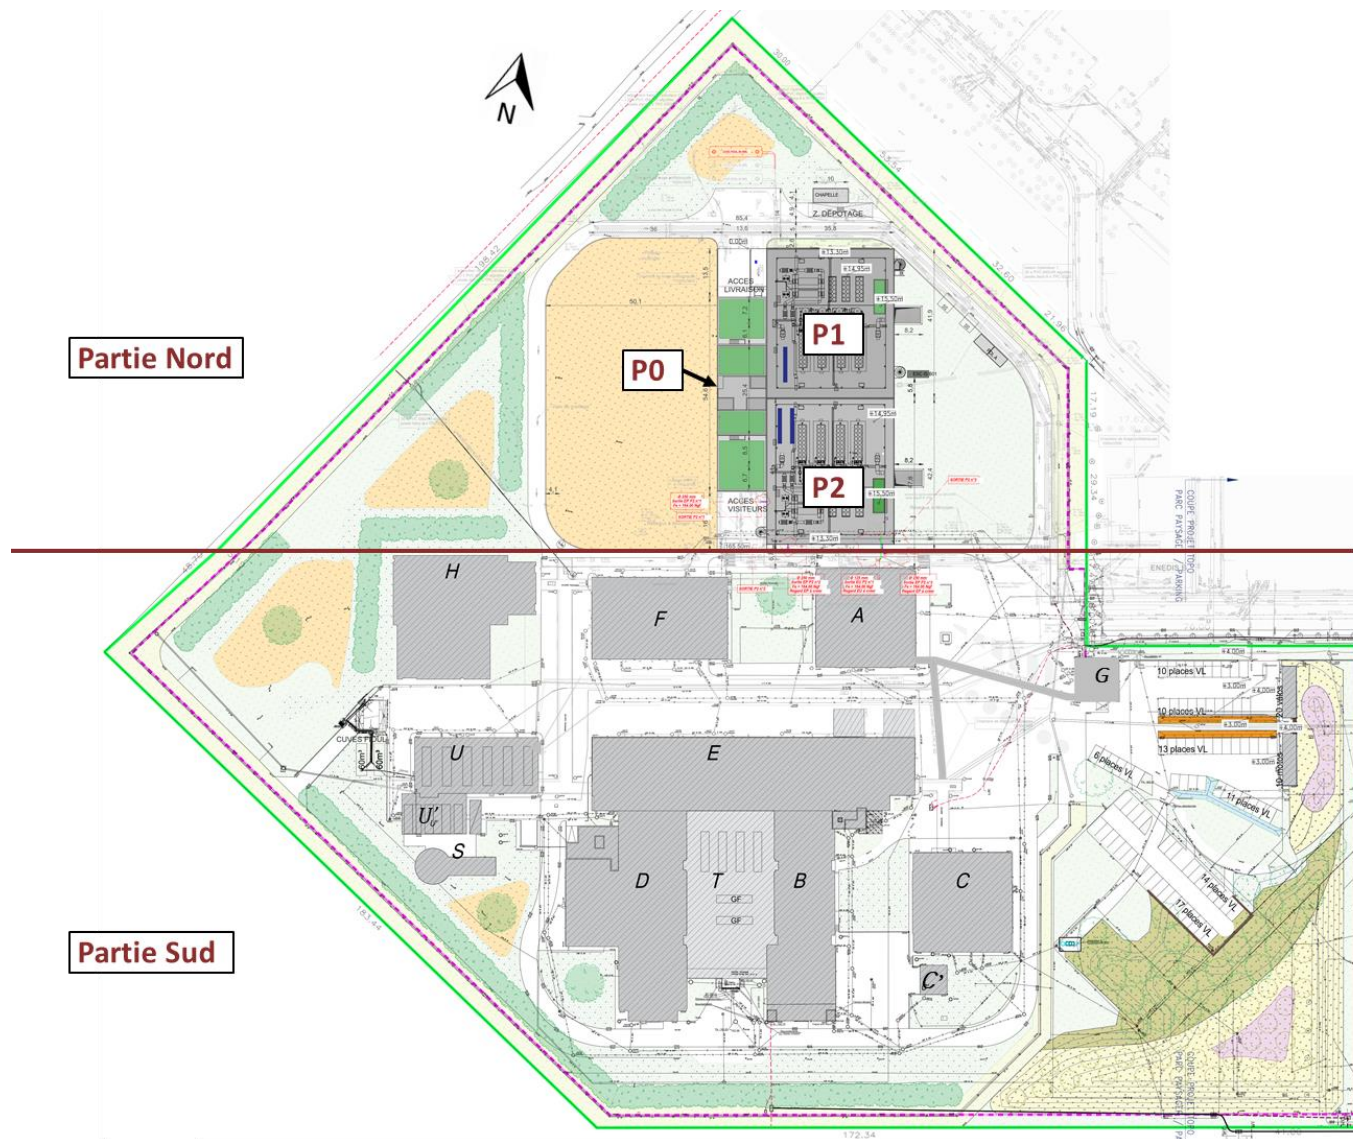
Plan masse du site dans sa configuration projetée avec P2
